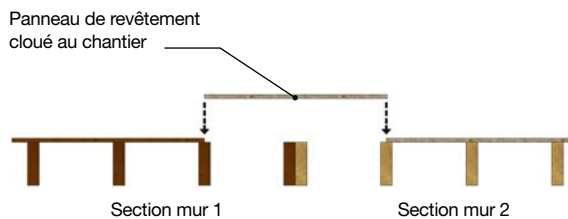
• Jonction entre deux murs de refend – Section de panneau au chantier – Coupe
